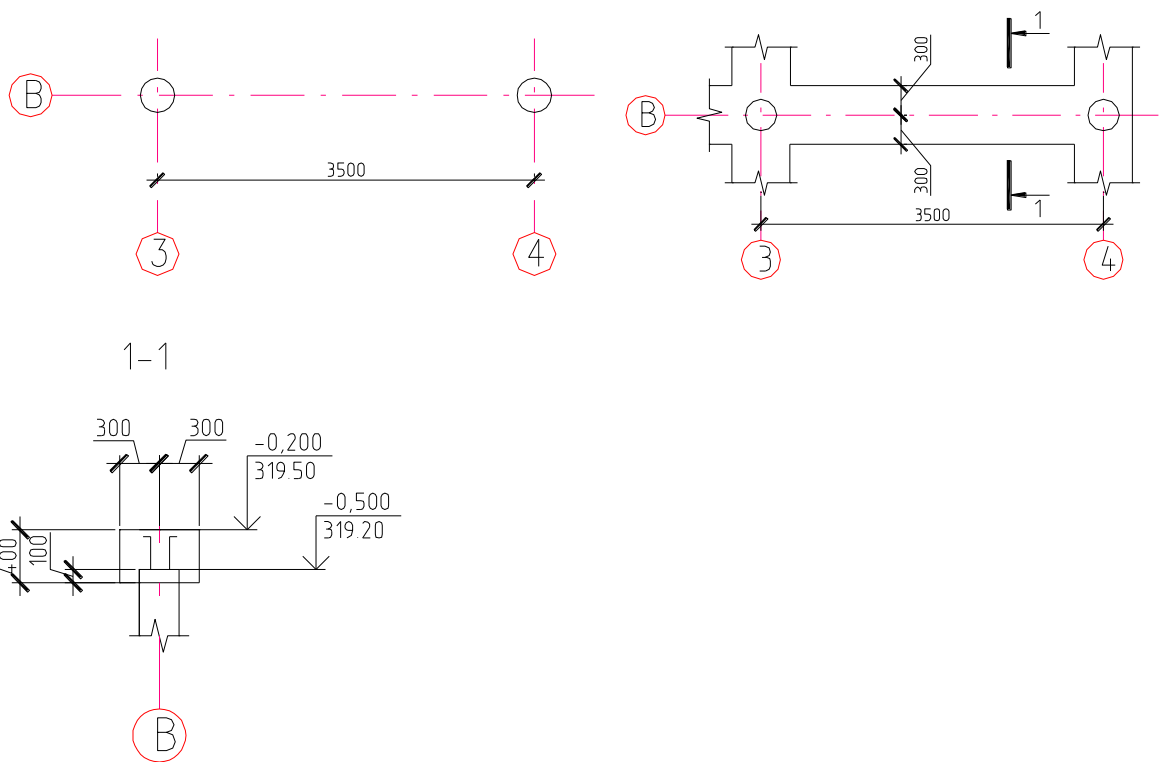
Конструкция ленточного фундамента на буронабивных сваях
